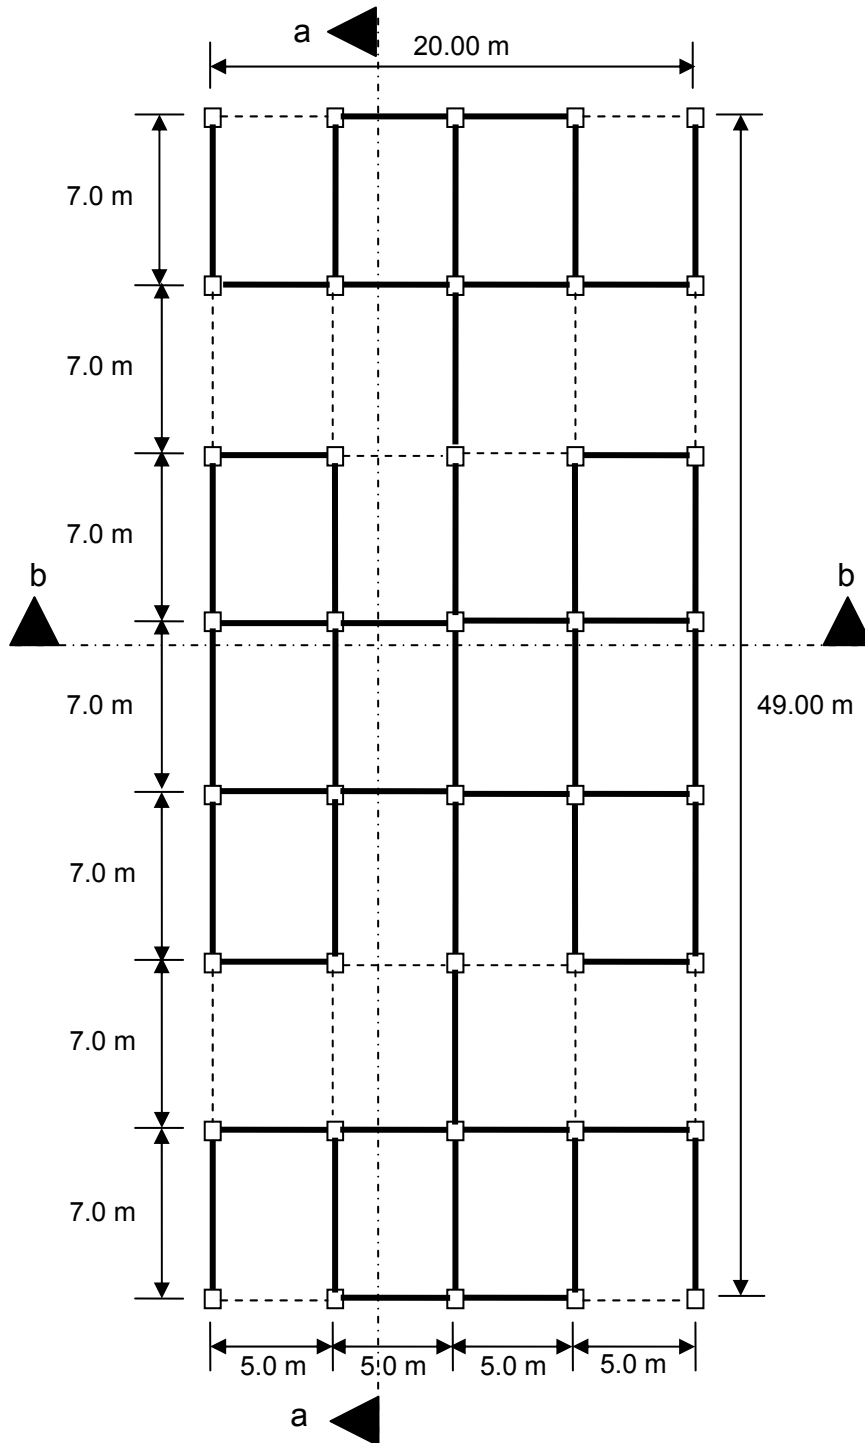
Planta estructural del edificio de 14 niveles para departamentos.
